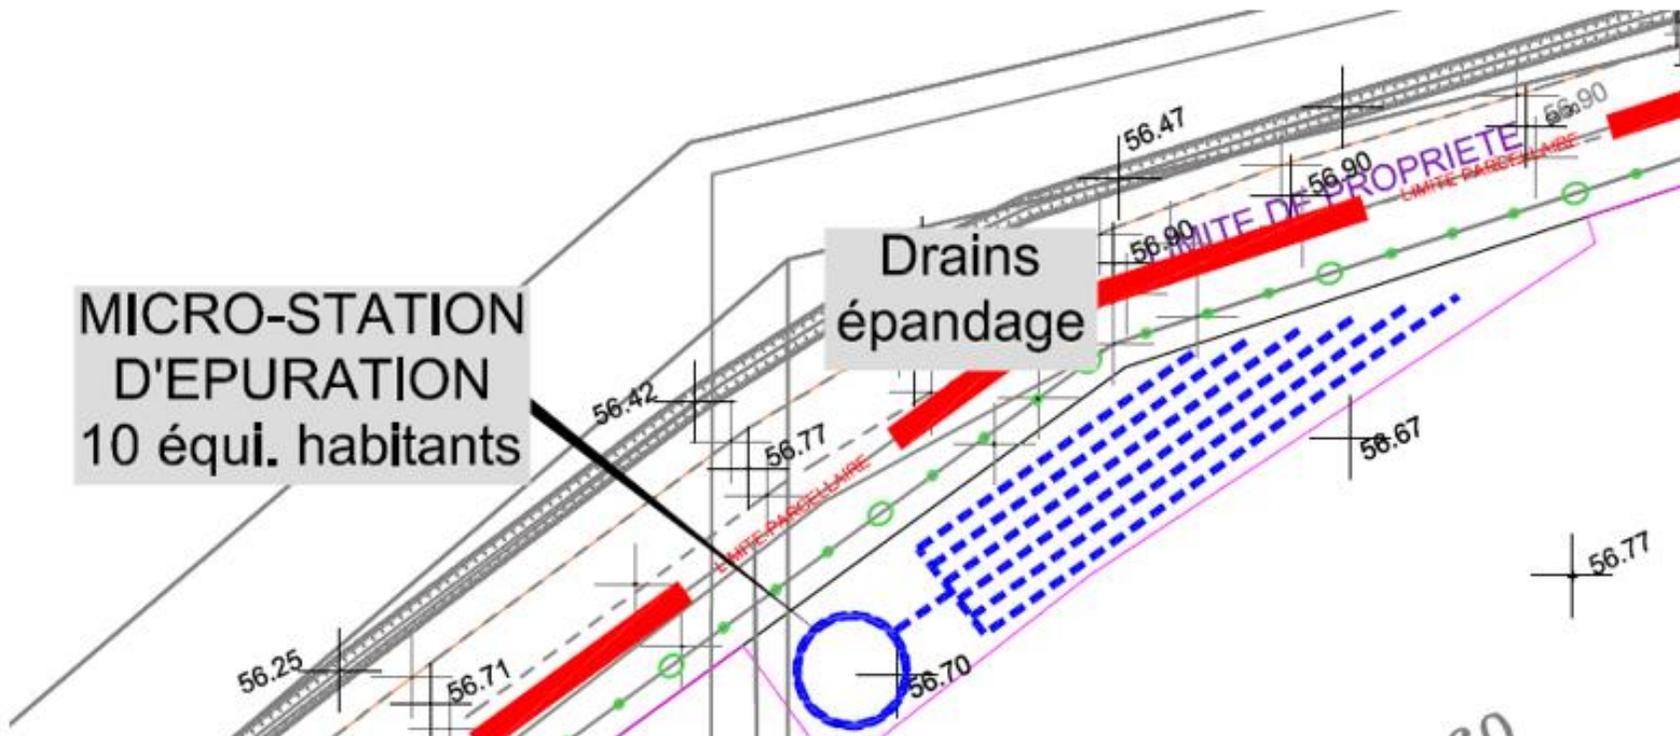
Plan d'implantation de la miro-station d'épuration (source : Plan de masse, SCEA OBTIFRUITTS, 08/10/2018)
